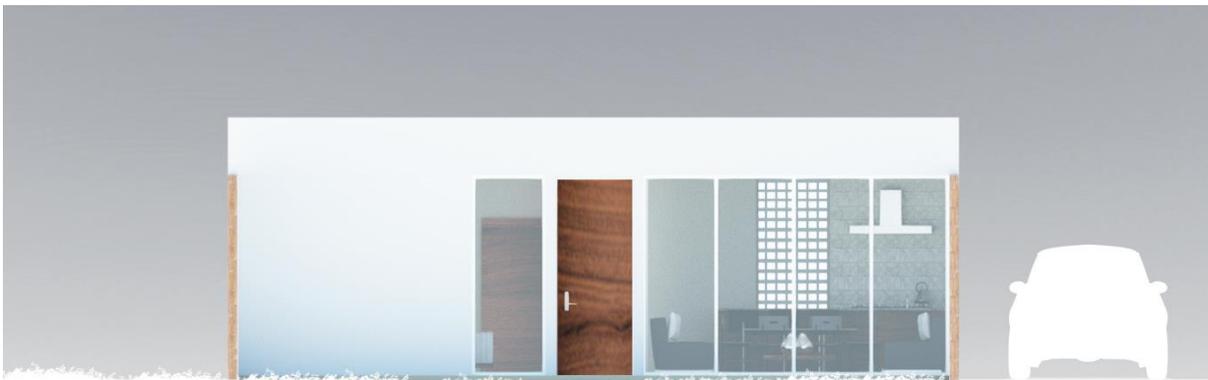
Corte longitudinal esquemático de vivienda adaptable
